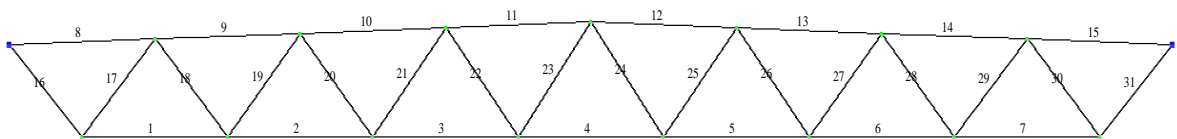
Конечно-элементная модель стропильной фермы СФ-1
